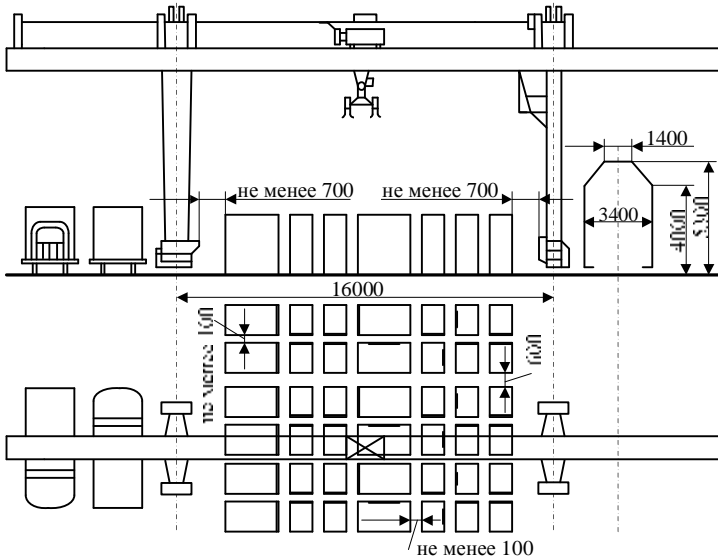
Схема механизированной перегрузки среднетоннажных контейнеров с использованием двухконсольного козлового крана
